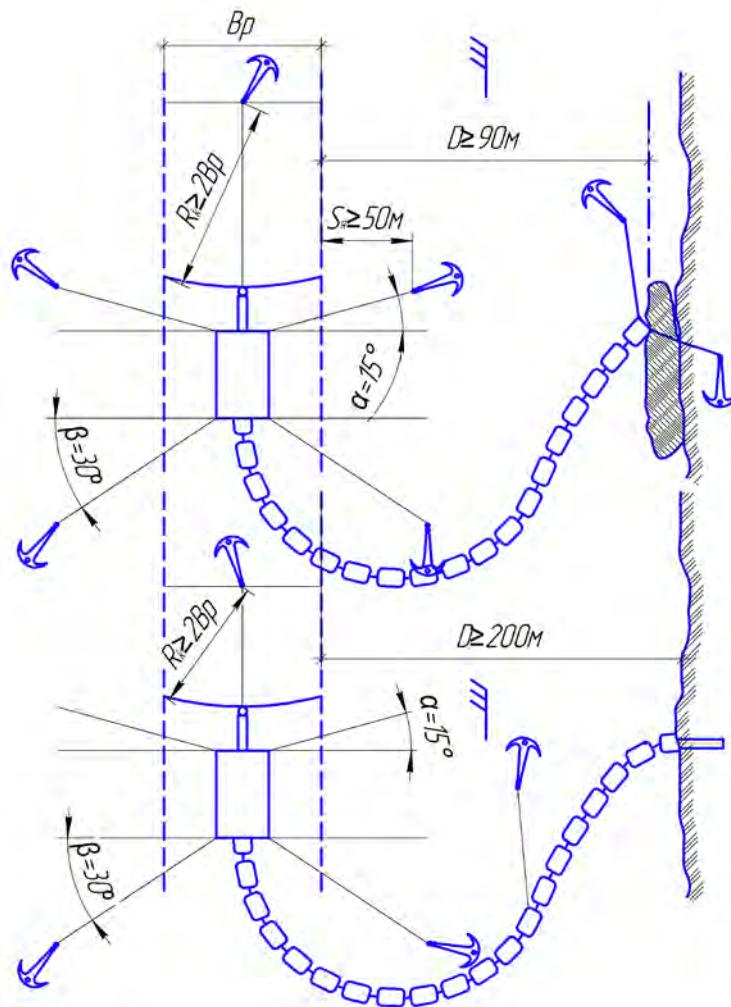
Схемы установки на участке работ папильонажного землесоса с рефулированием грунта на подводный отвал (вверху) и на береговой отвал (внизу):
